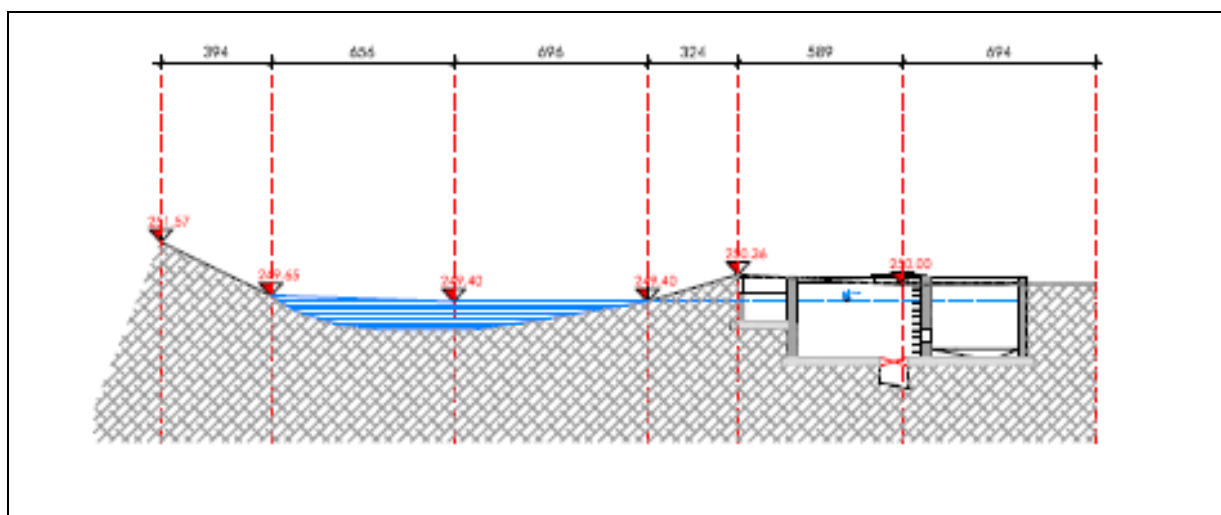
Sezione del locale centrale con vista a valle della briglia con il vano di alloggiamento della turbina e lo scarico di restituzione delle acque turbinate
